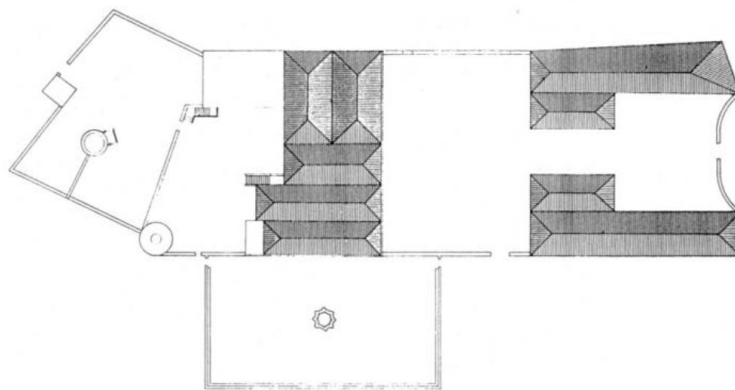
Planta de cobertura e planta do piso térreo original¹²³
